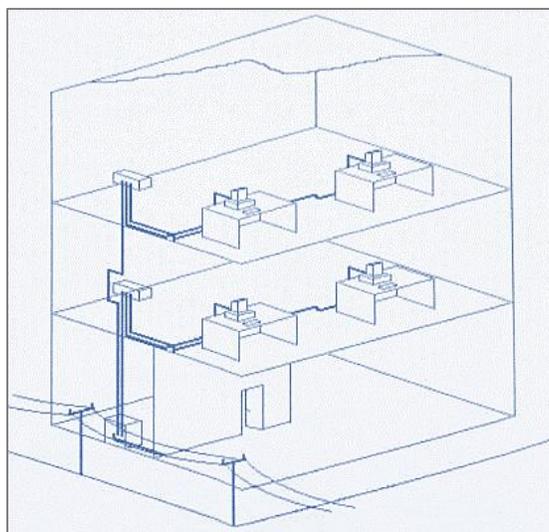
Elementos del cableado estructurado. Diagrama simplificado
